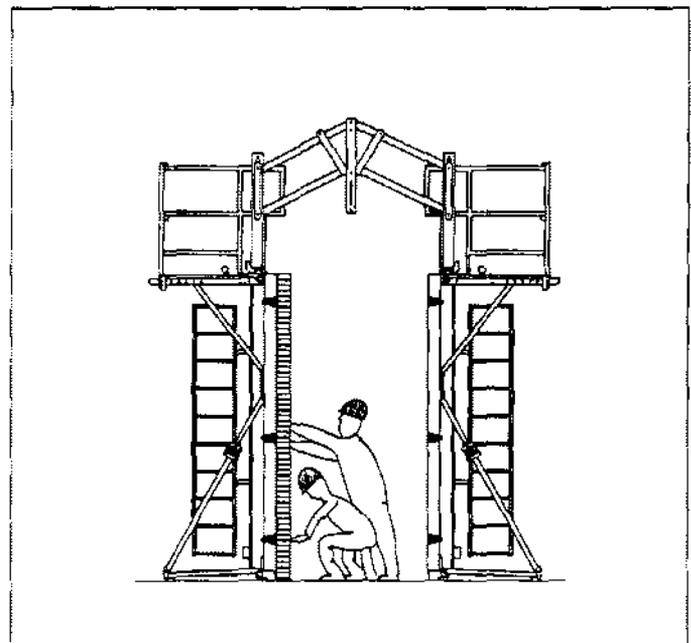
Mise en place du ferrailage et des inserts (p. 166)
